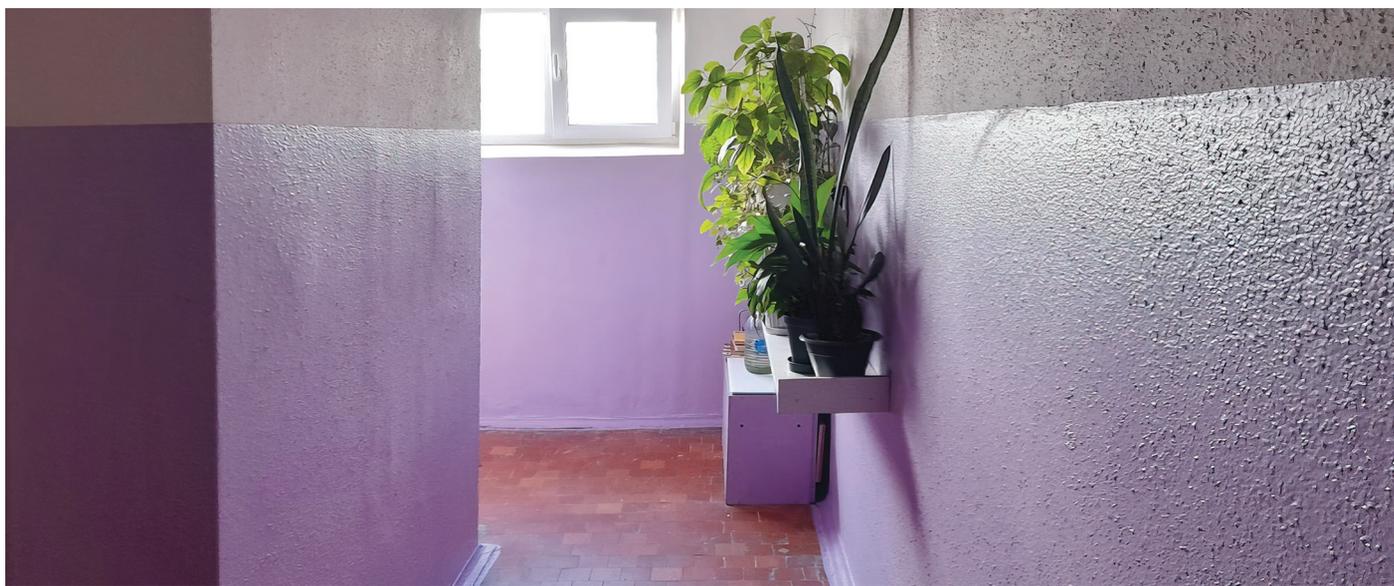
МКД по ул. Набережная, 51 – отремонтированные лестничные площадки. Фото: ИЭГ
